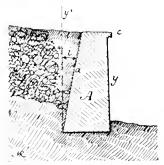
Coupe verts ale d'un mur le barrage le torrent.
